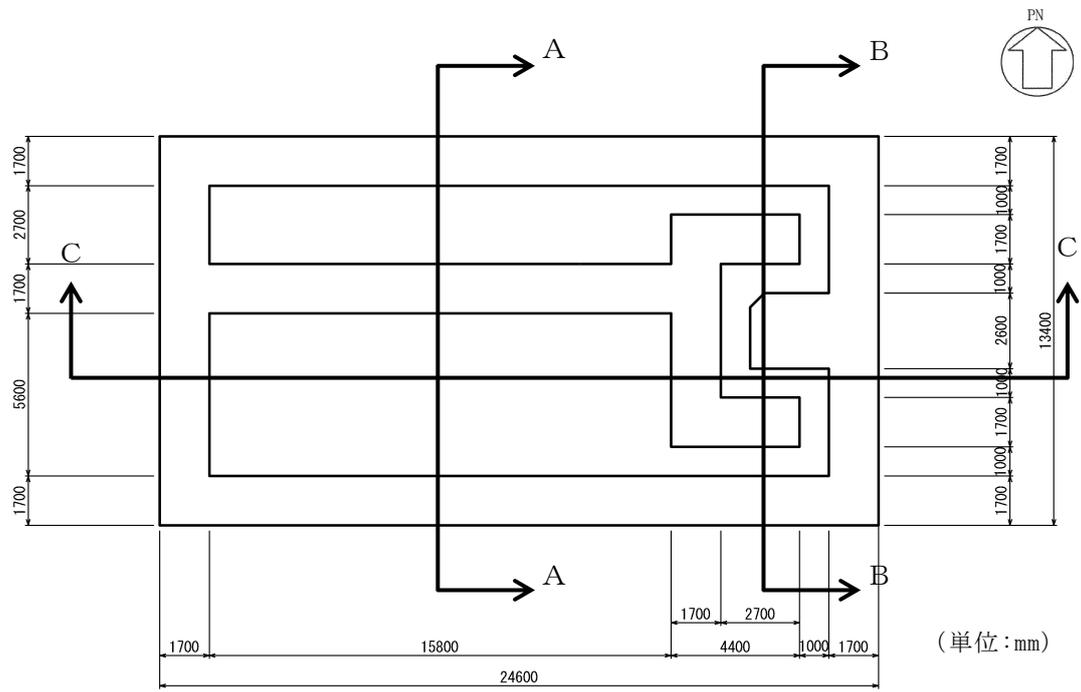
第1 ベントフィルタ格納槽 平面図
